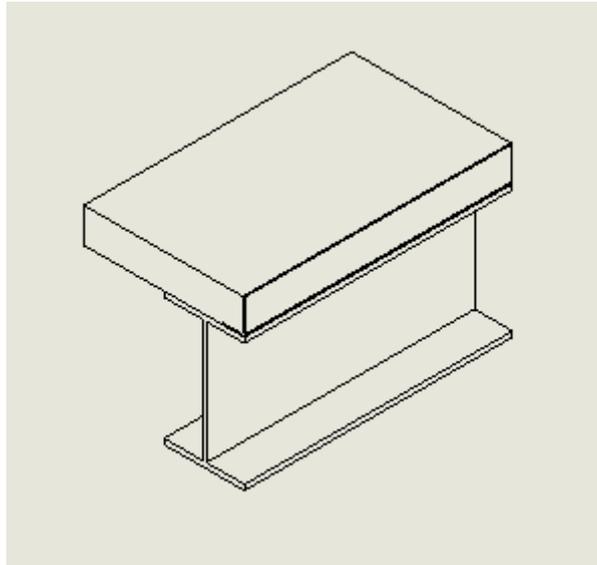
Perspectiva da laje sobre o perfil estrutural. Sem escala.
